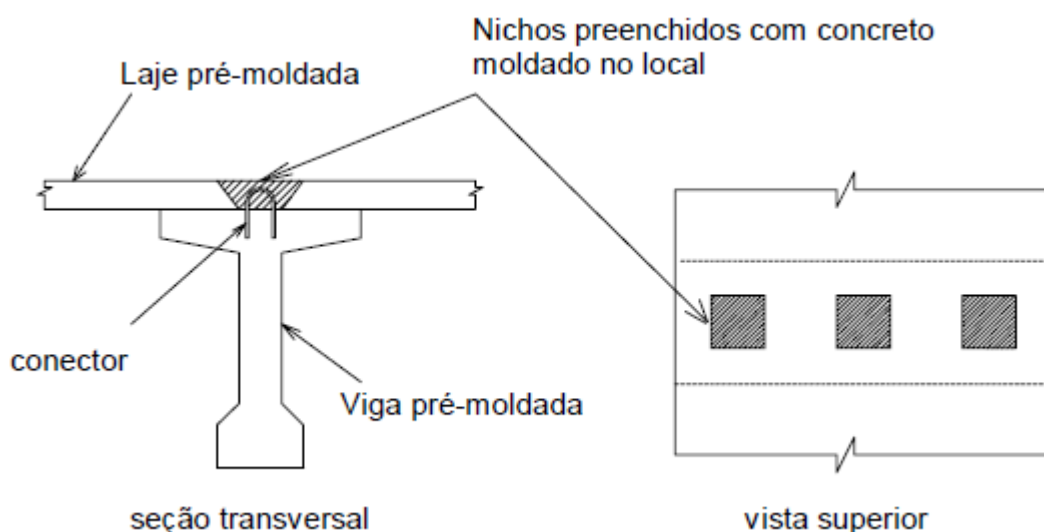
Ligações dos modelos com estruturas pré-moldadas.
